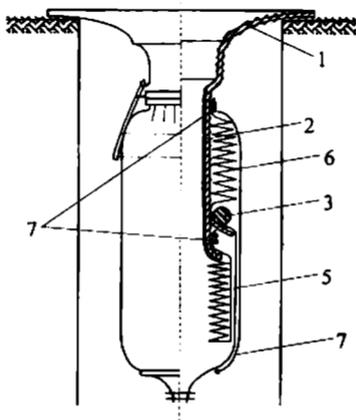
Схема устройства подачи рукава с двумя последовательными пакетами
